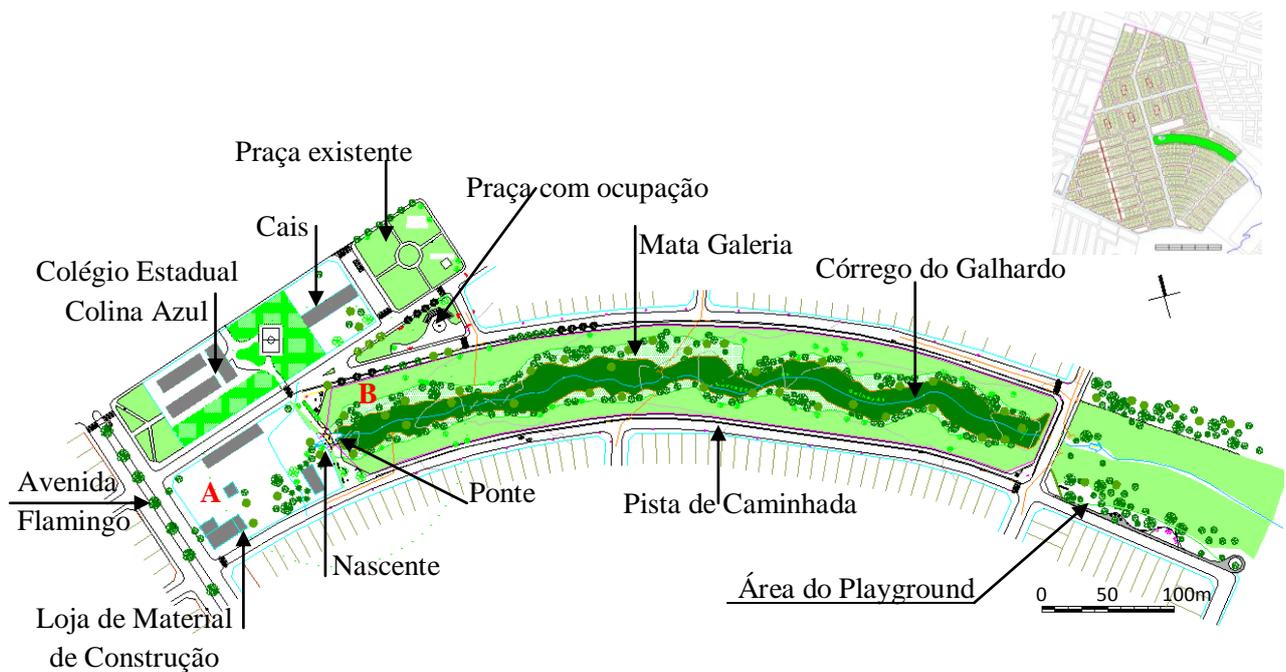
Planta da APM 20 denominada Bosque Colina Azul.
